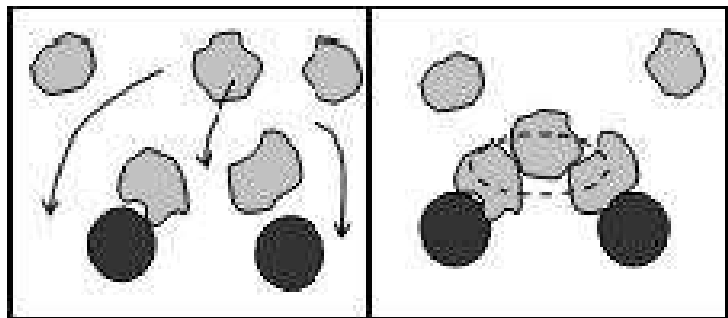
représentation en plan d'un blocage de granulats à travers deux armatures.
